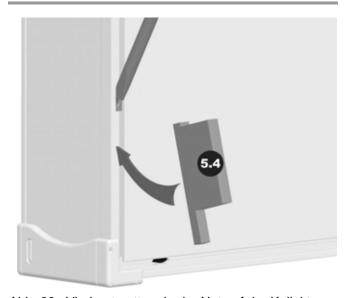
Vierkantmuttern in der Nut auf der Kollektorrückseite mit einem Schraubenzieher ausrichten und mittels der Montagehilfe (5.4) fixieren.
